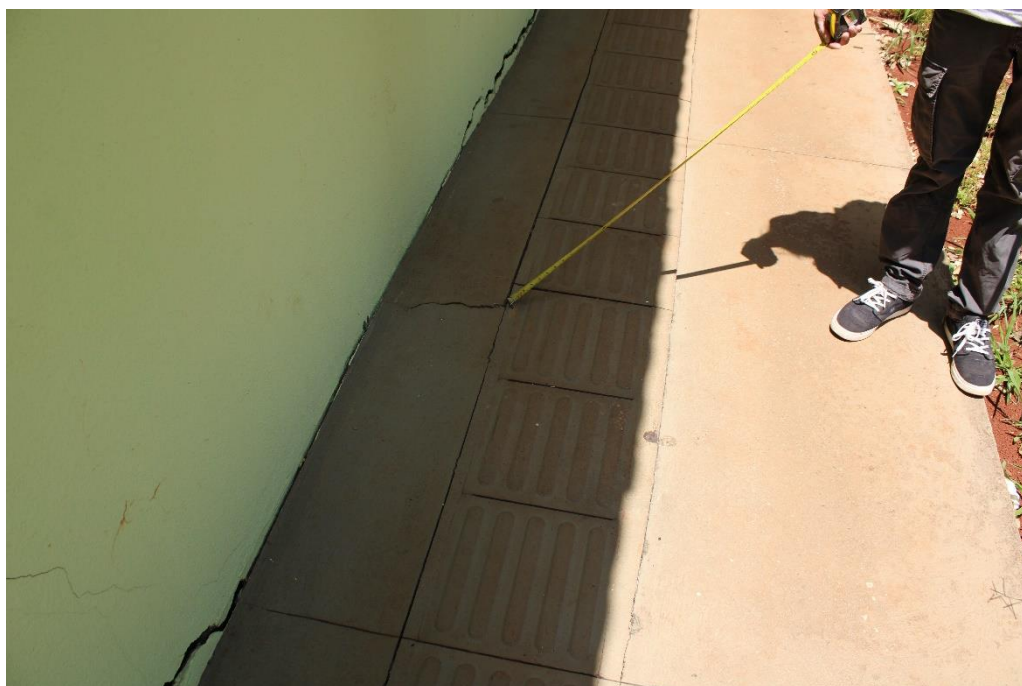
Vista parcial da Fachada Frontal, destacando trinca em calçamento externo em concreto desempenado.
